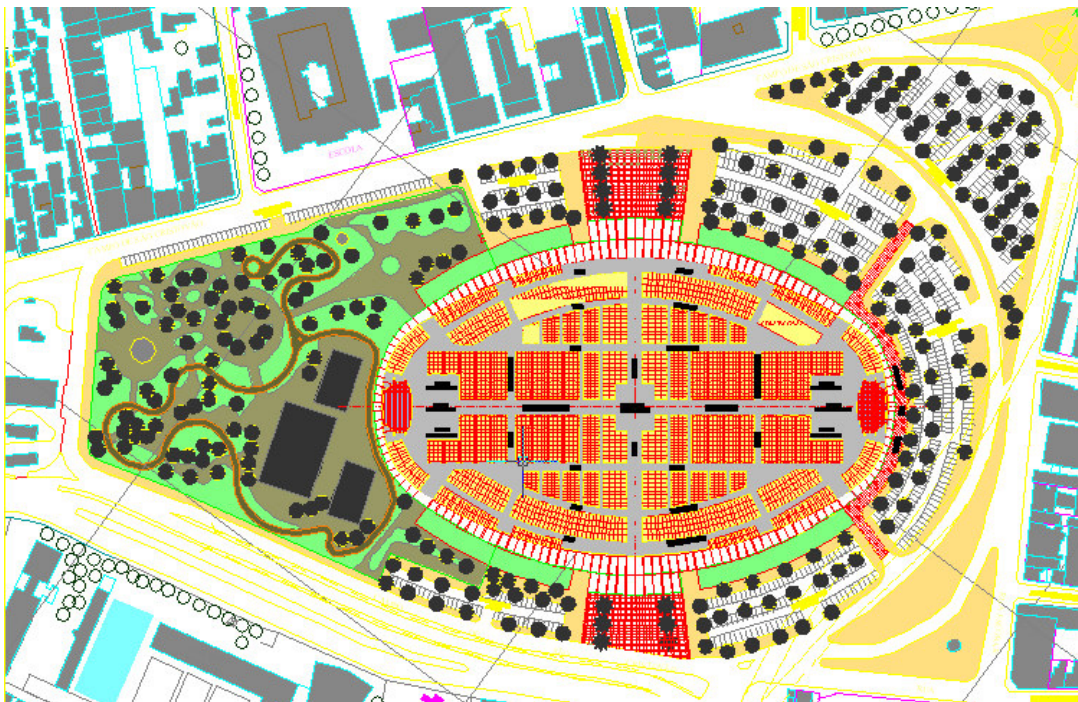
Planta de Situação do projeto da Archi 5. (fornecida pelo arq. Bruno)
